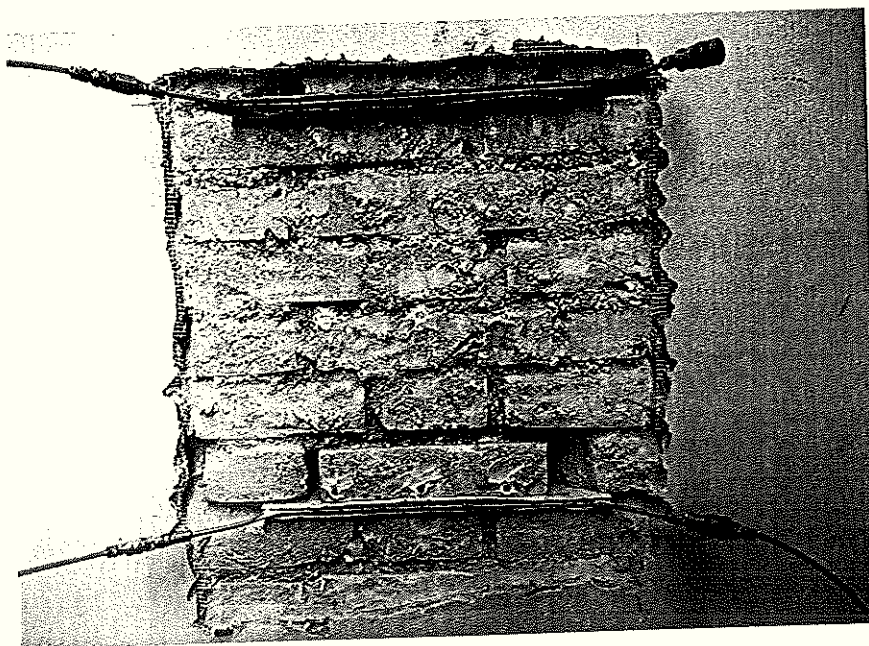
Corpo murario interessato dalla prova con martinetto piatto doppio (cfr. tav. 1).
